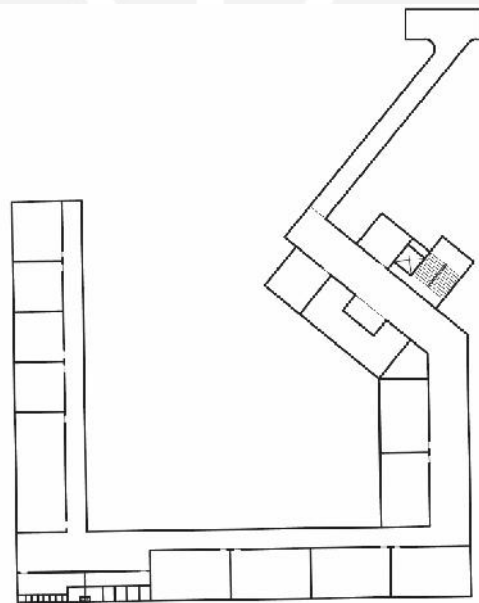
Denah Skematik *Lantai 1* Gedung Pertunjukan
